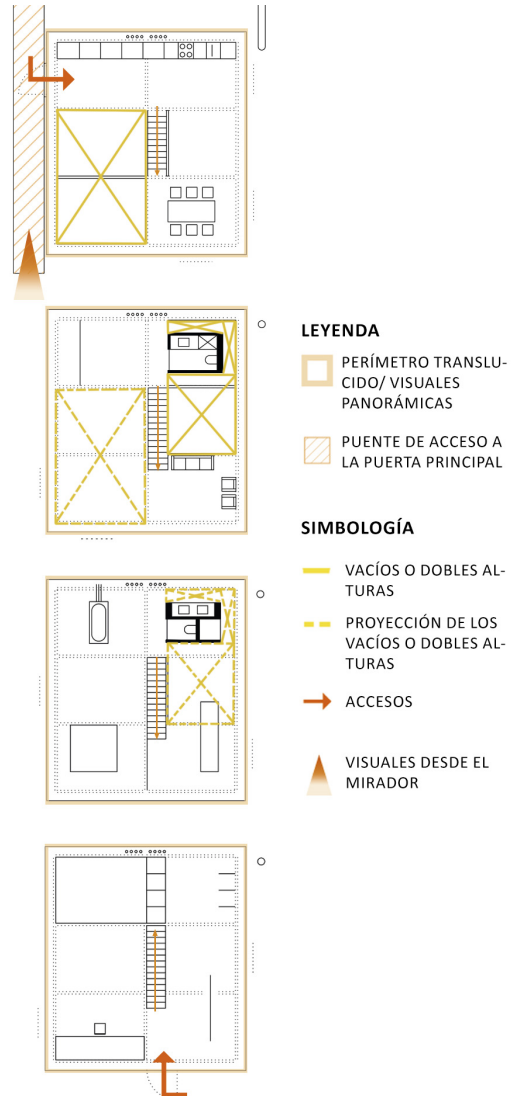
Planta libre y espacios de libre configuración Casa R128.
